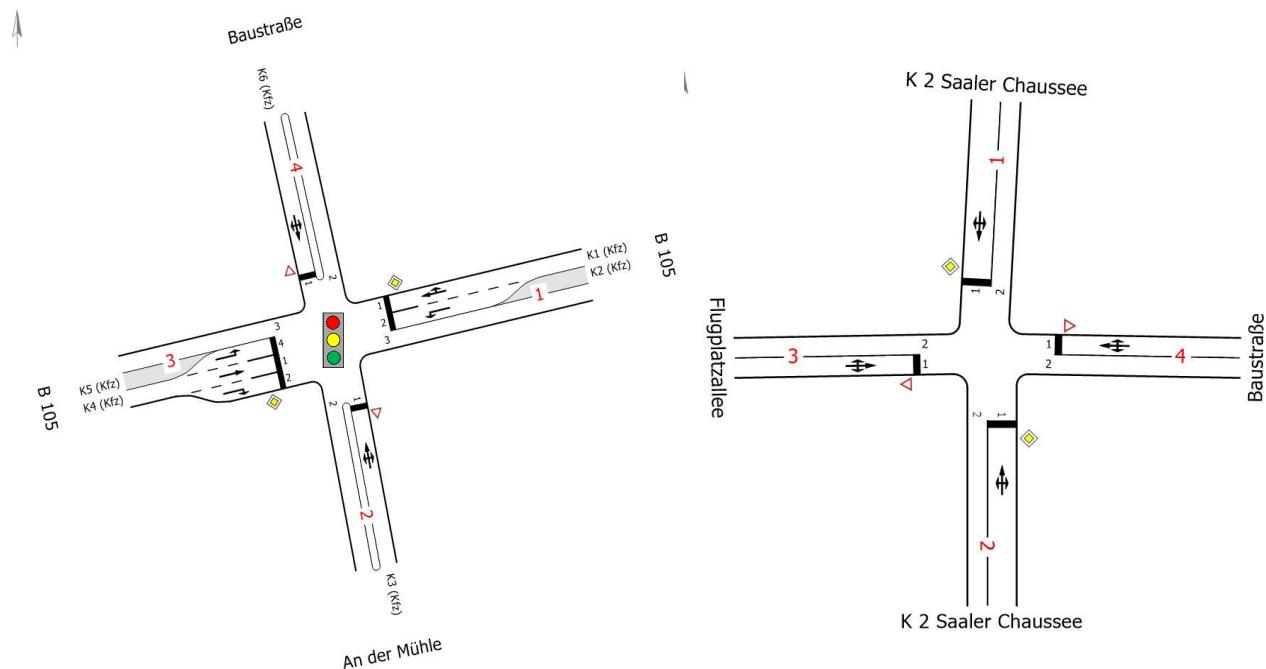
Ausbauempfehlungen der Anschlussknotenpunkte (Vorzugsvariante Planfall 1)
